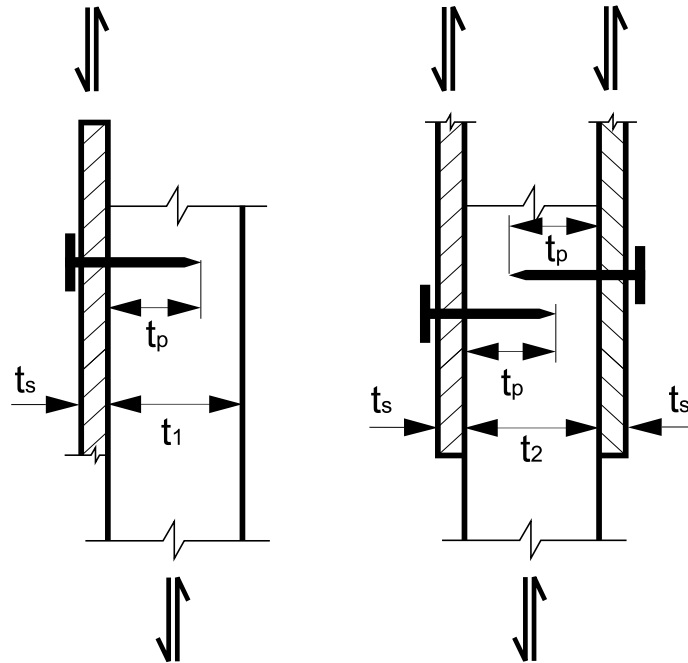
Configurações de ligações de elementos de madeira e aço com pregos em corte simples
